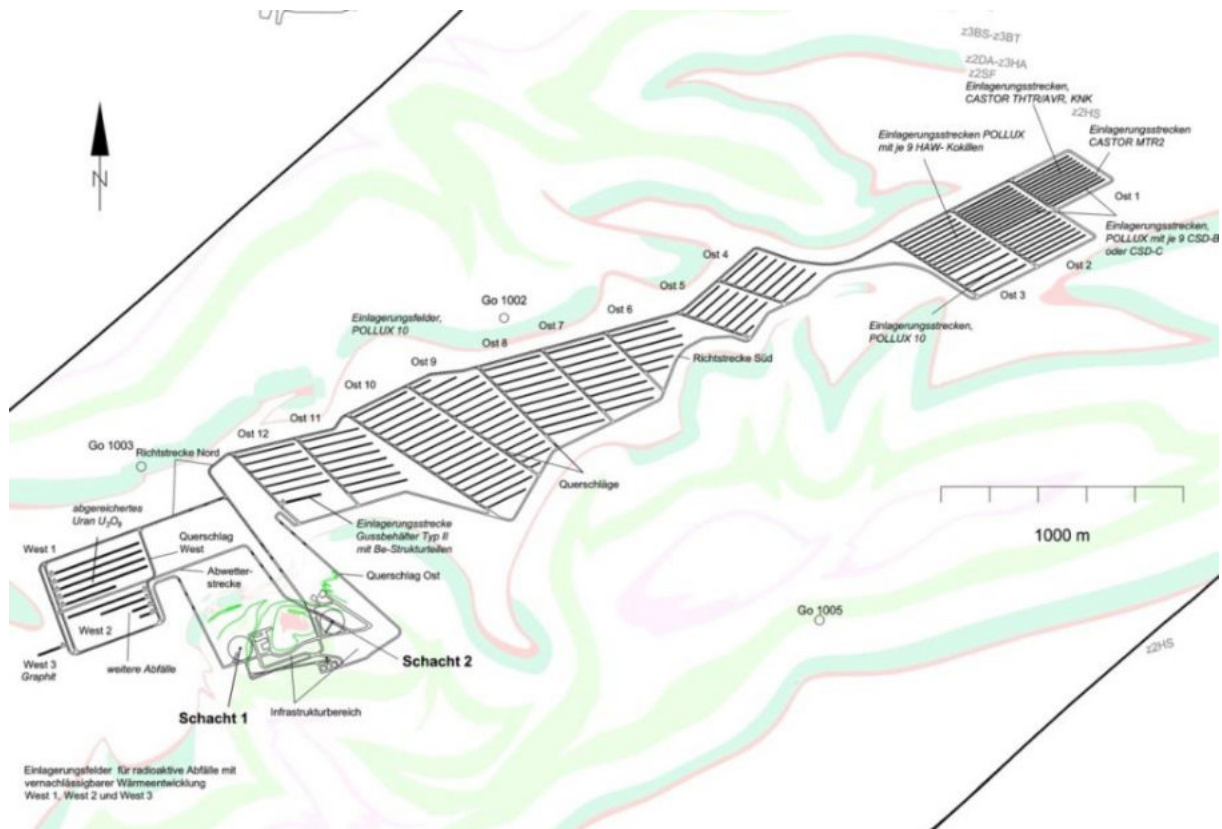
Darstellung des Grubengebäudes für die Streckenlagerung auf der Einlagerungssohle (870 m Sohle) (GRS, 2012)
